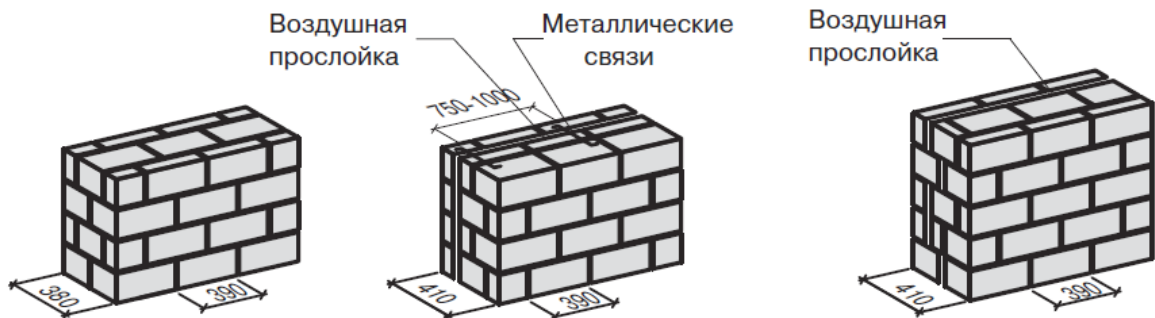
Кладка из бетонных камней (блоков). 1951 г.
